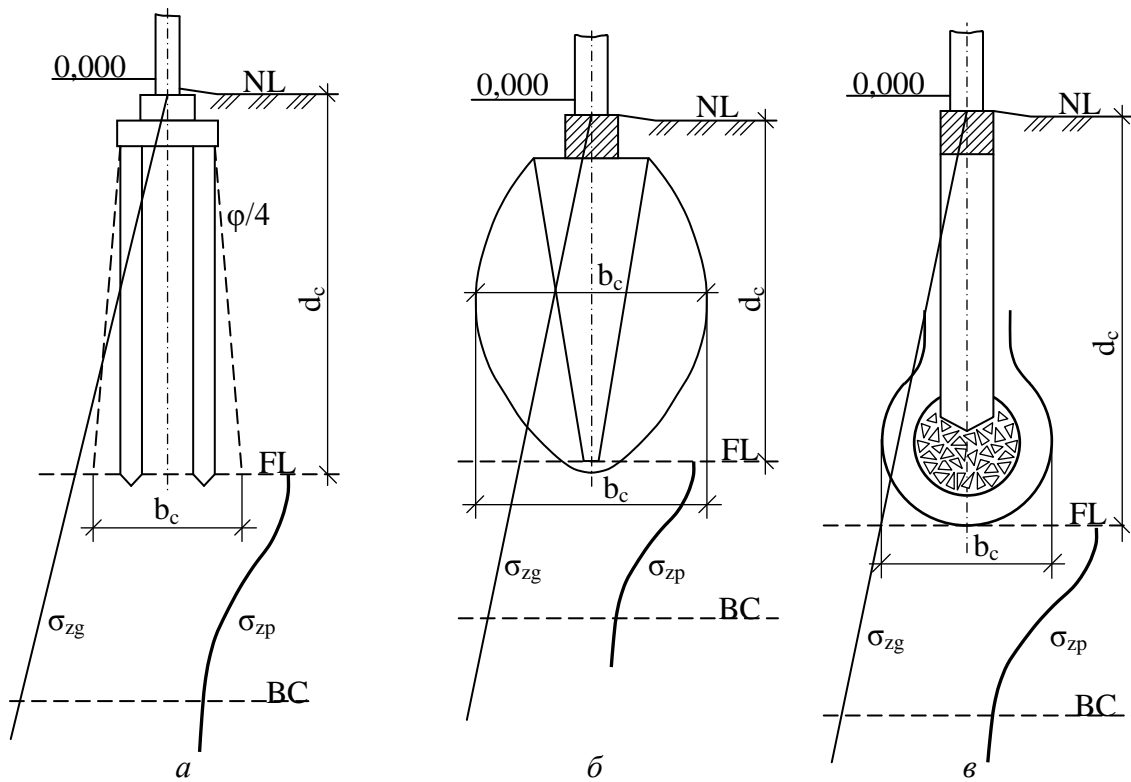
Схеми для розрахунку осідання фундаментів:
